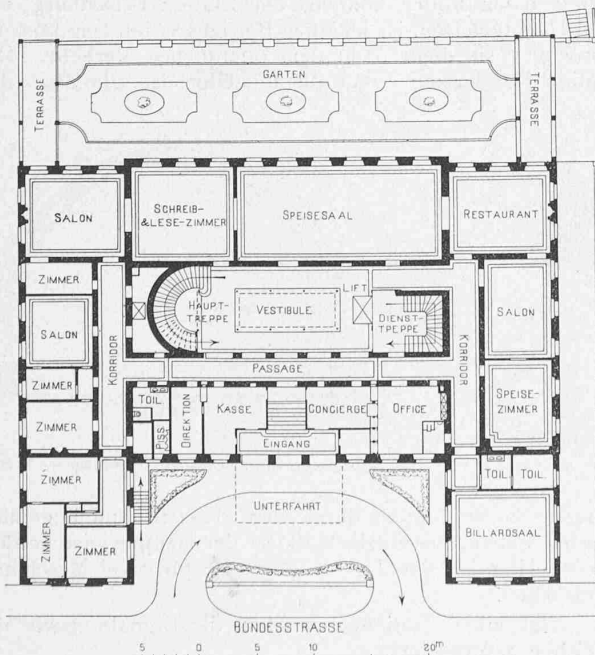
Erdgeschoss-Grundriss vor dem Umbau.
